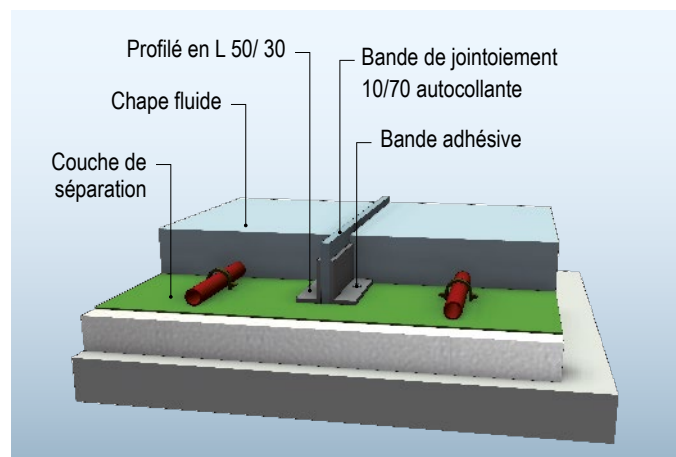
Variante d'exécution 3 : Joints avec profilé en L
